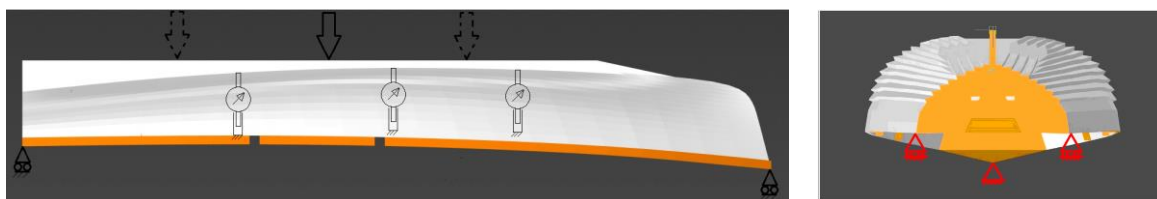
Граничные условия и схема нагружения для натурных испытаний
